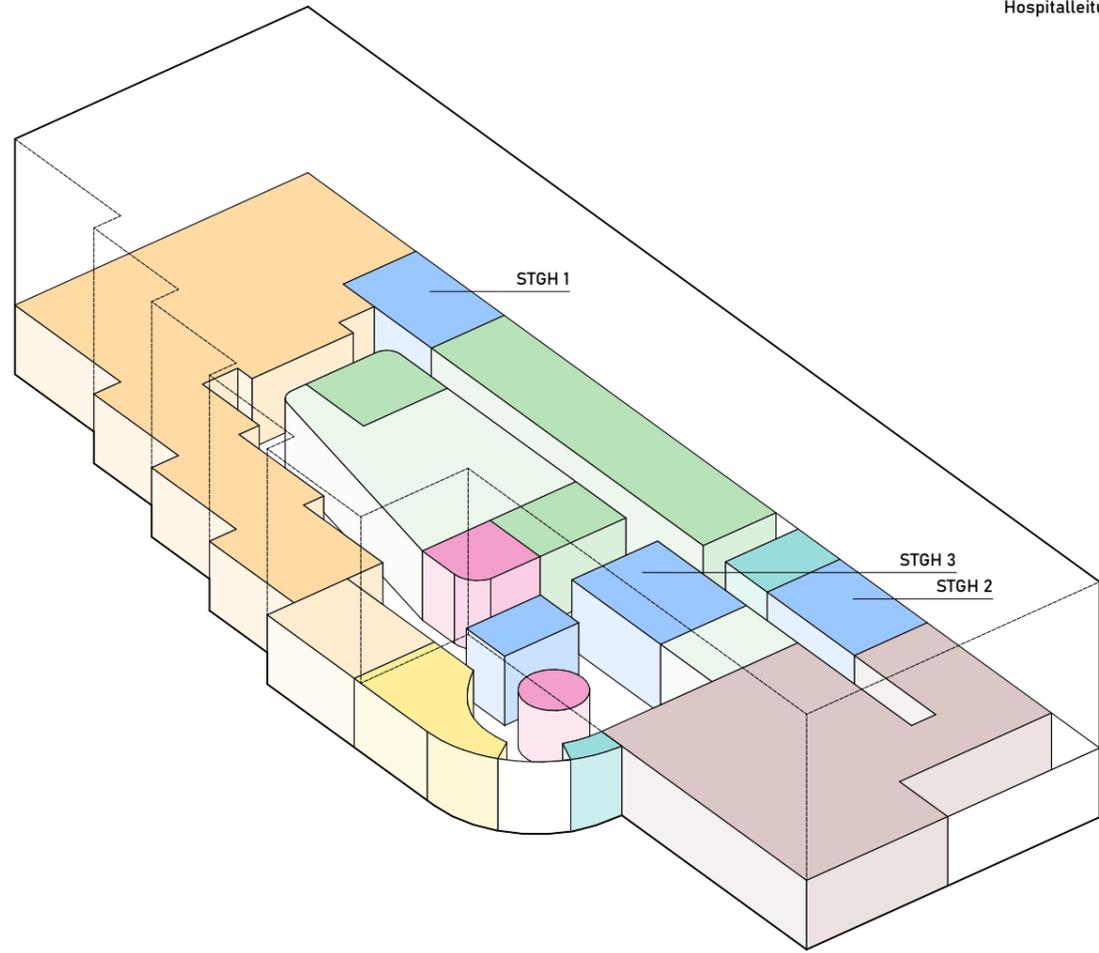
Grundriss EG Raumorganisation M1:400
